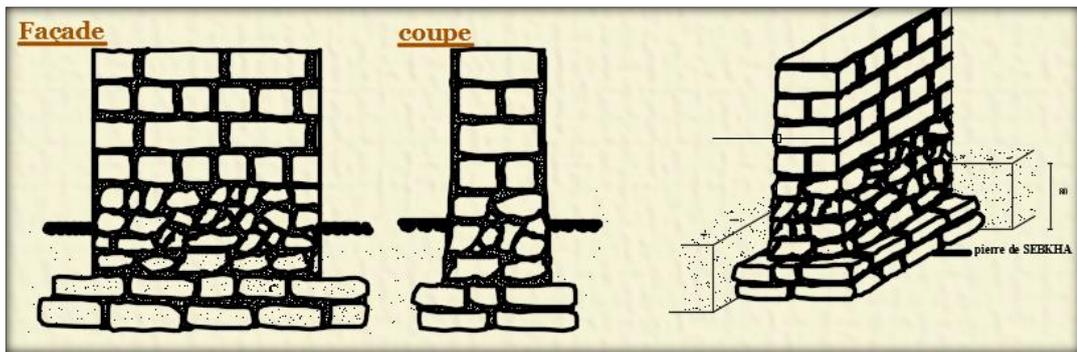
Detail constructif des fondations en pierre. Source : auteur
